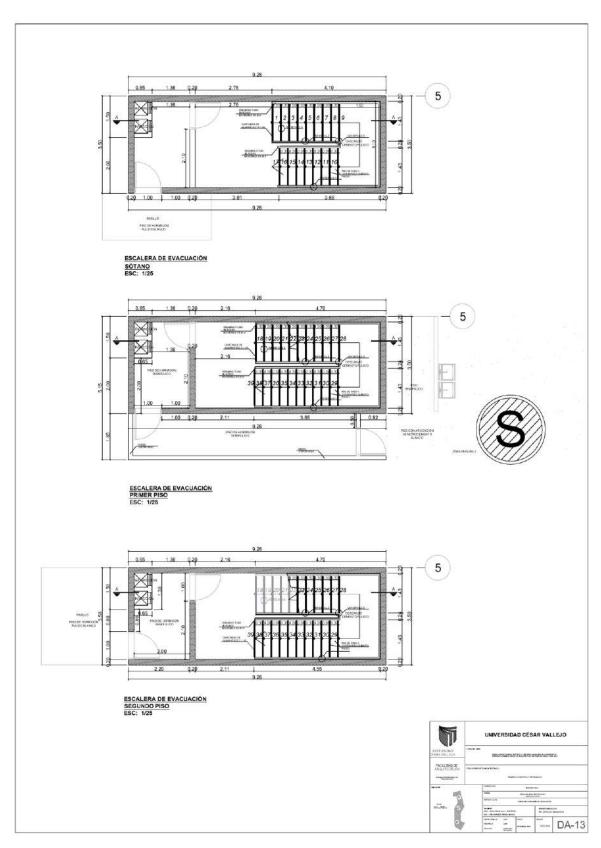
Detalle de escalera de emergencia - DETALLES ARQUITECTÓNICOS
